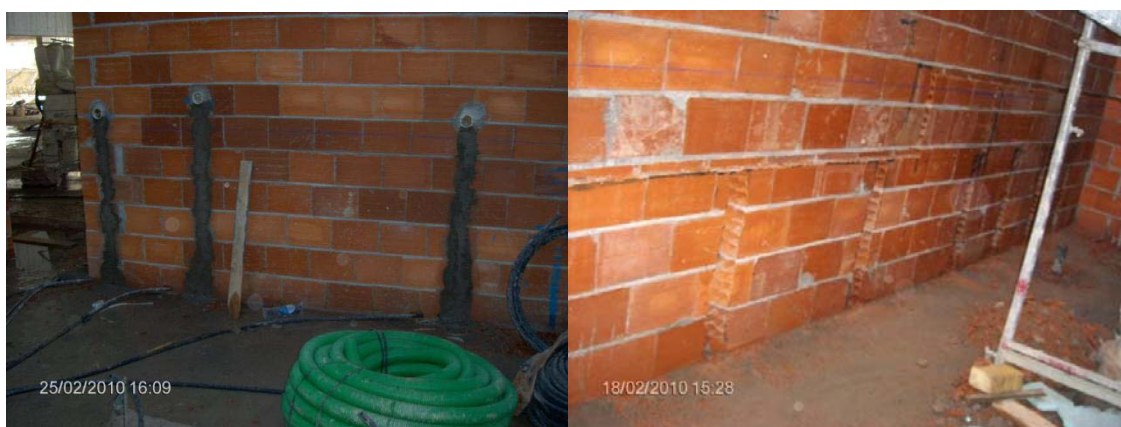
Execução das Paredes de Alvenaria de Tijolo
